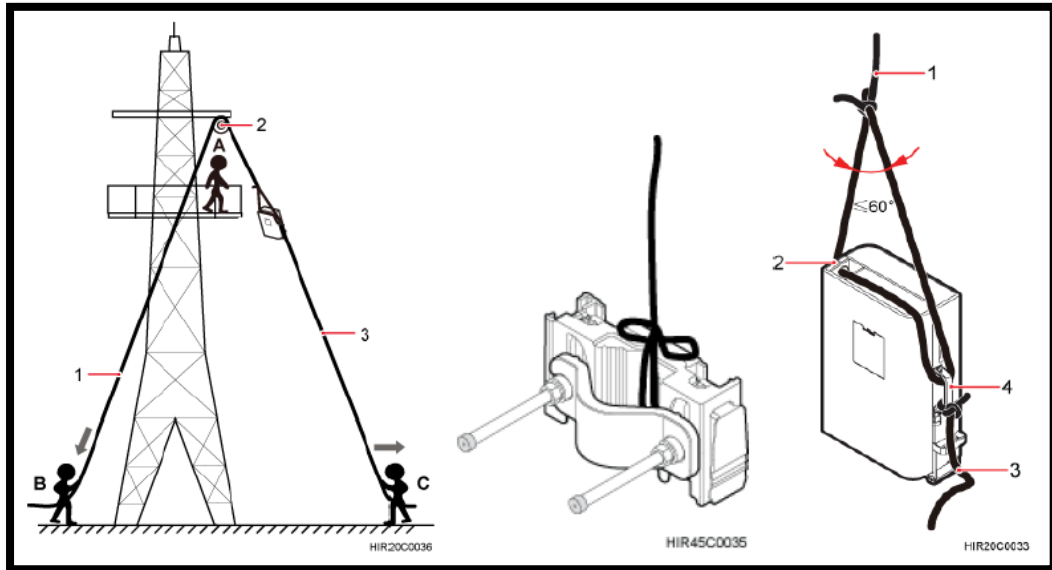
Forma correcta de asegurar la RRU para subirlo a la torre
